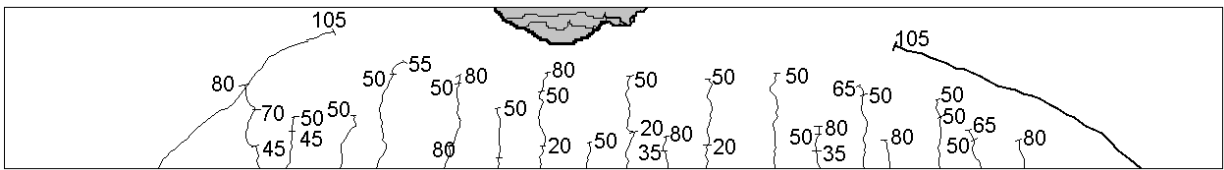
Mapa de fissuras da Viga V6A075
